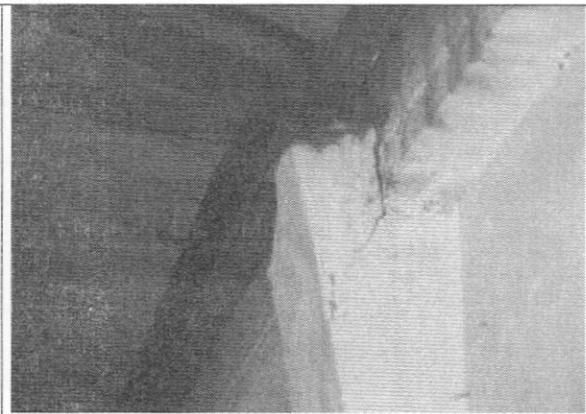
Grieta en ménsula de apoyo estructura de cubierta
